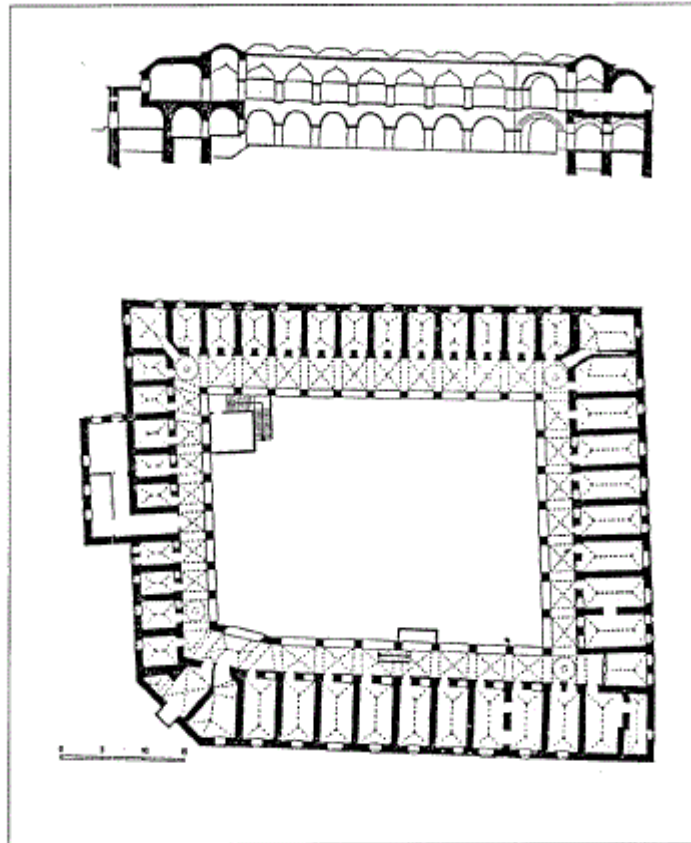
مسقط افقي لبادستان سليمان باشا أسفل مسجده في ترافنيك
